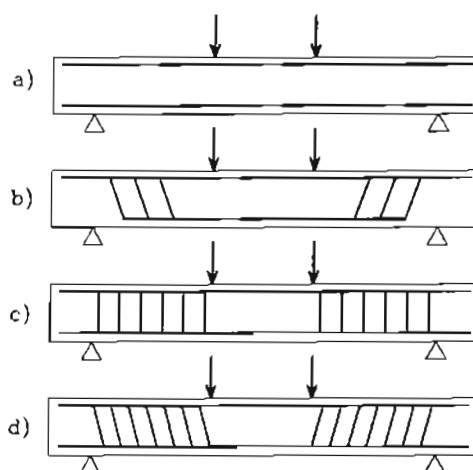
Disposições possíveis de estribos nas vigas
